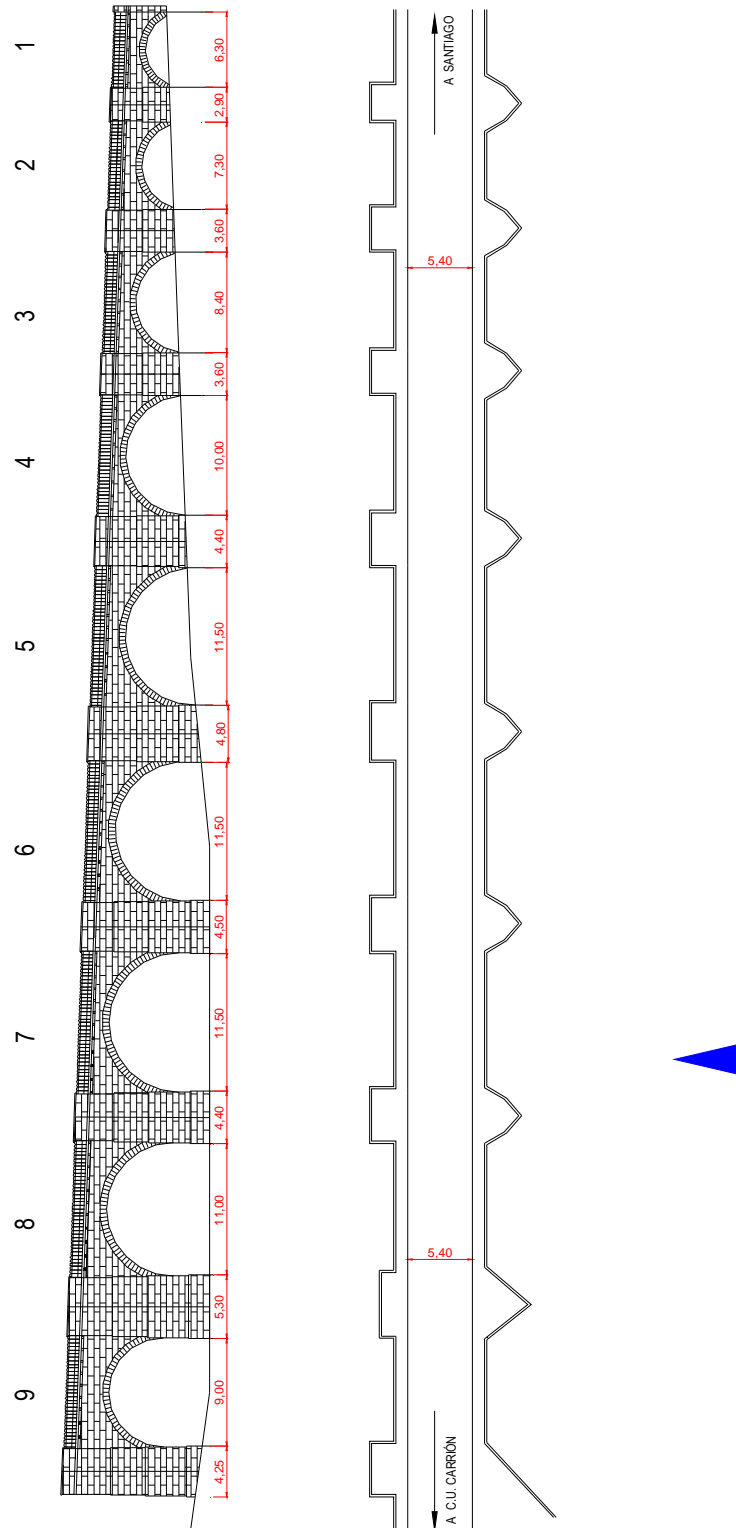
Planta y alzado de aguas arriba del puente en Carrión de los Condes
